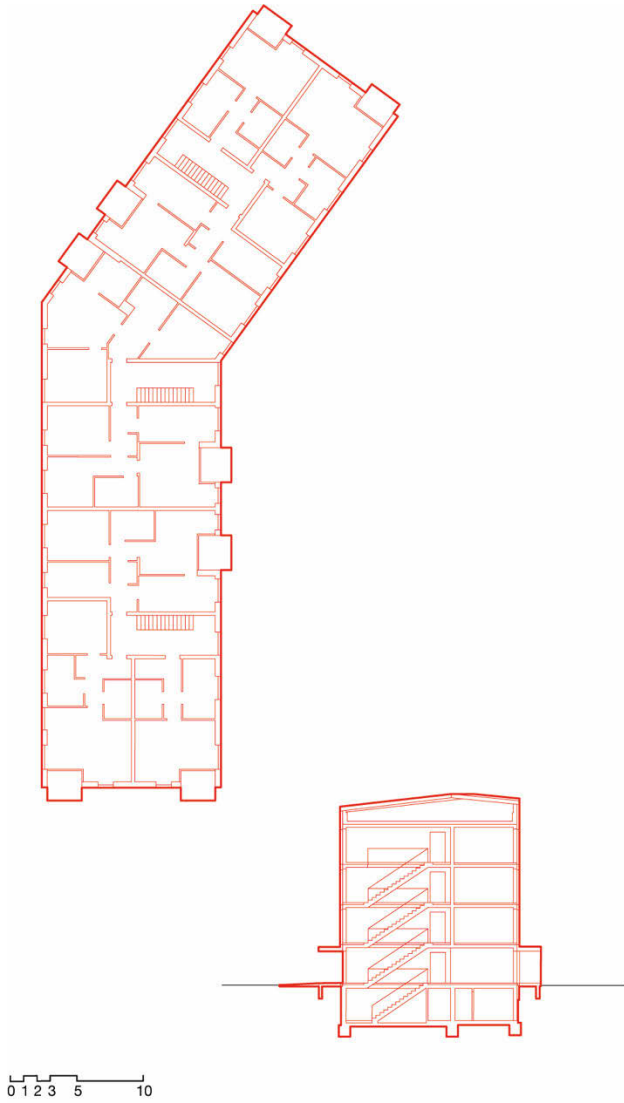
Grundriss – Schnitt, Ersatzneubau, Buchheimer Weg
